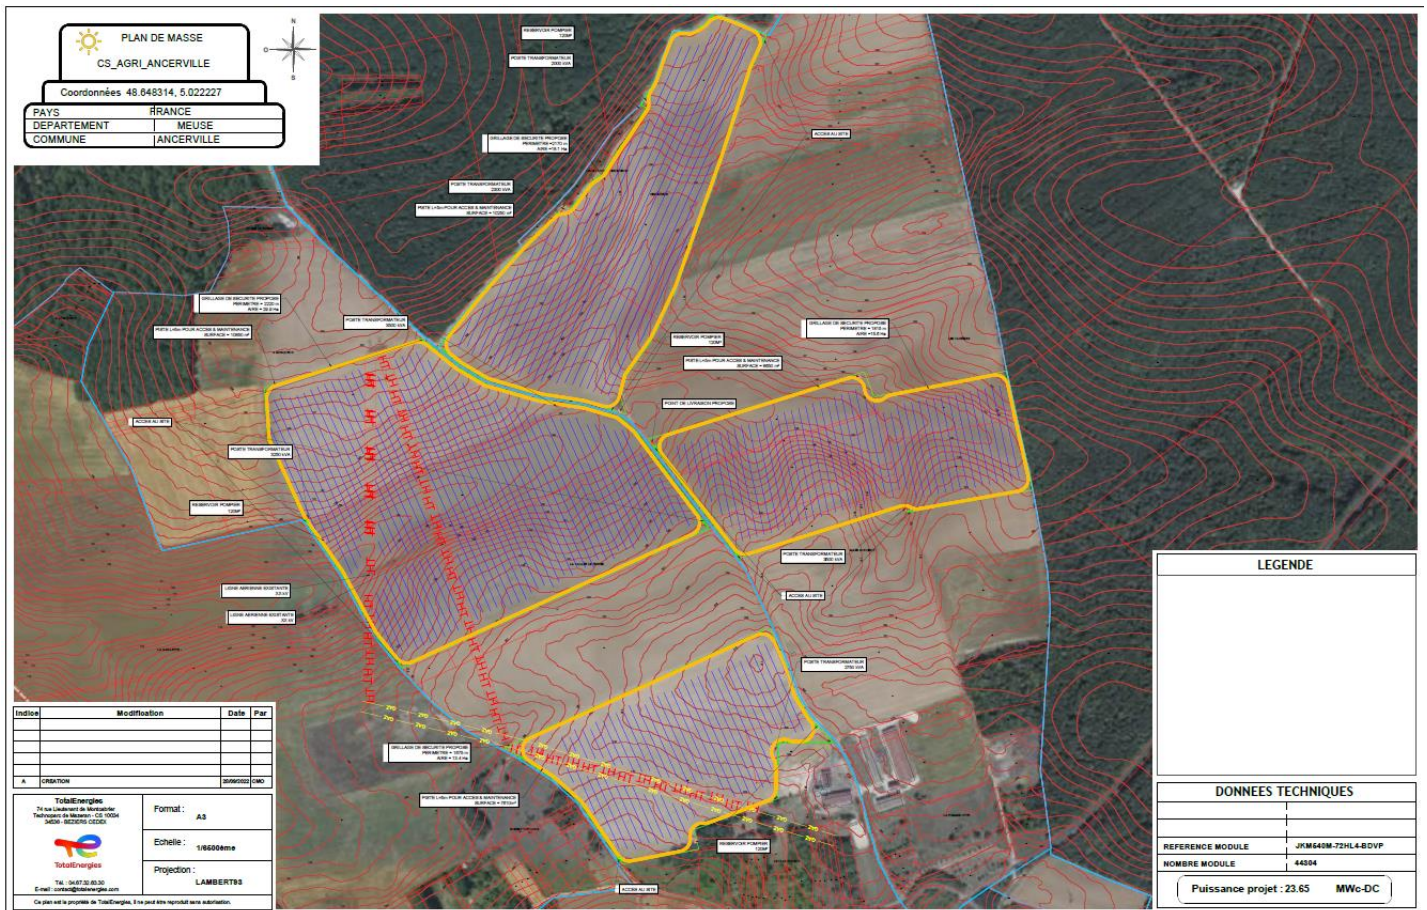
Plan de masse de la zone concernée par les panneaux verticaux
